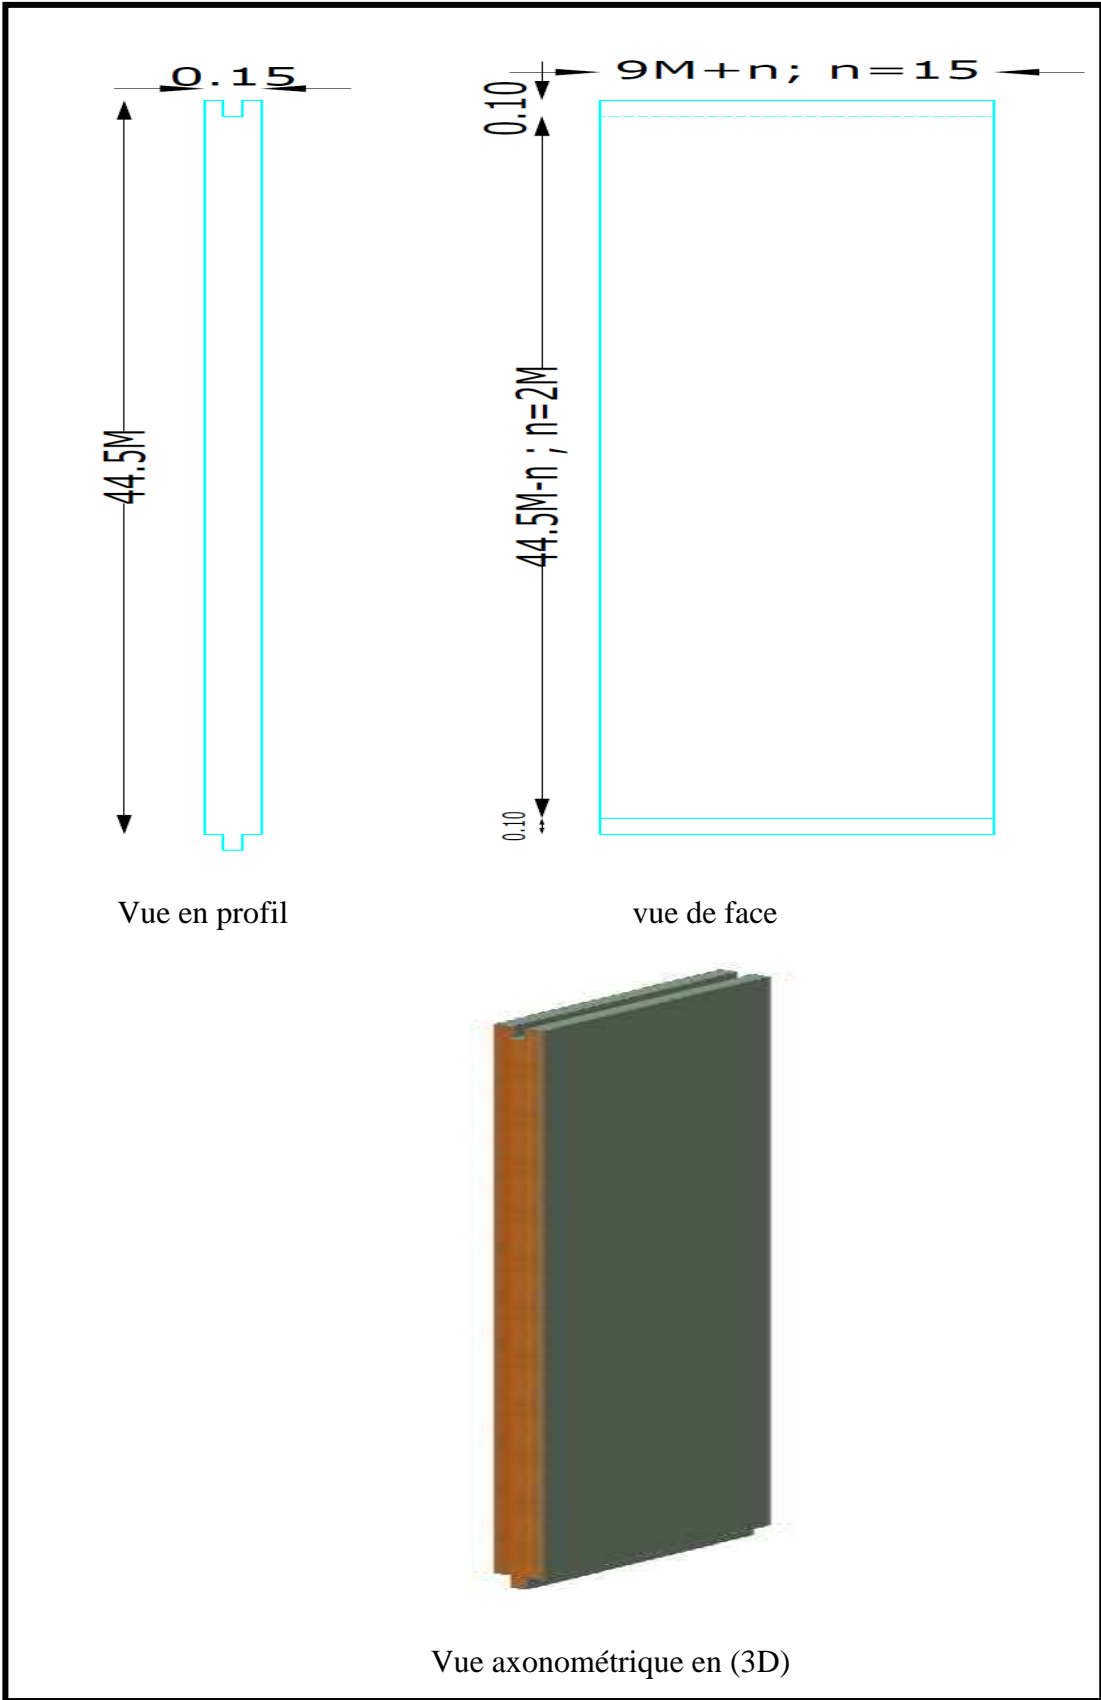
Panneau de façade cas d'un poteau intermédiaire
